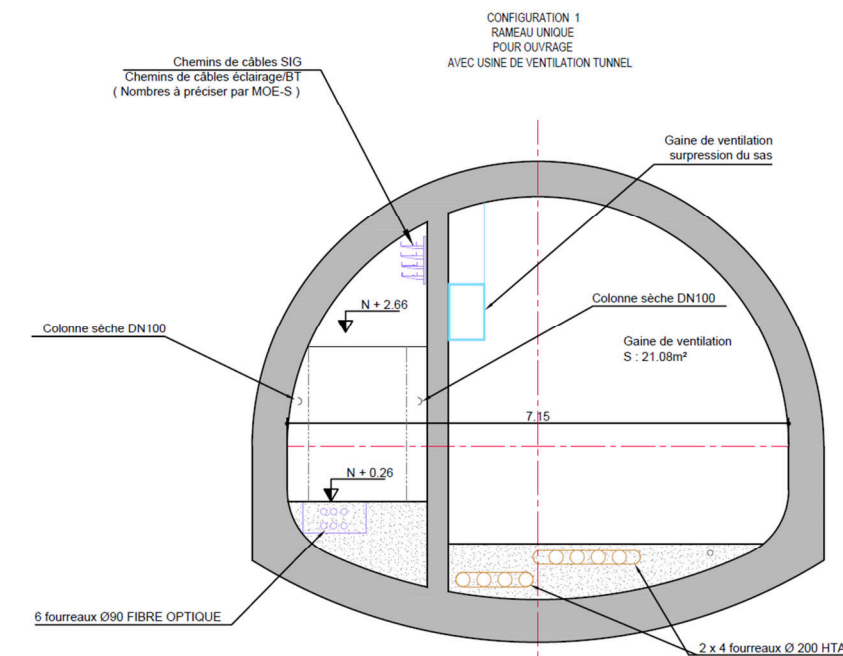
Coupe type d'un rameau bi fonctionnel (sécurité + ventilation)
